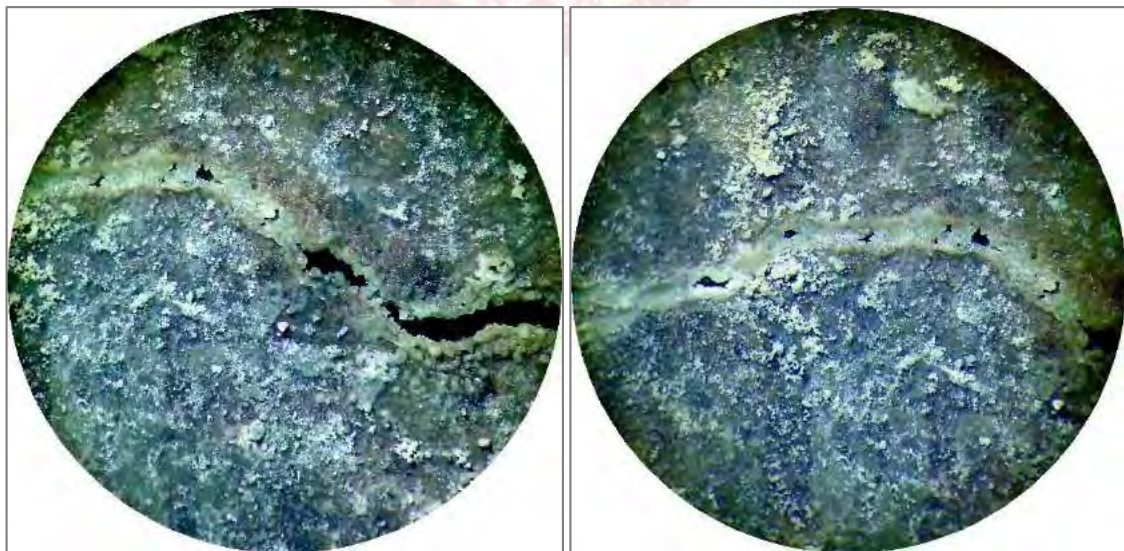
Sellado de fisuras (< 1.00mm de ancho) del concreto a base de bacterias a los 58 días (Renato H Mendoza N).
